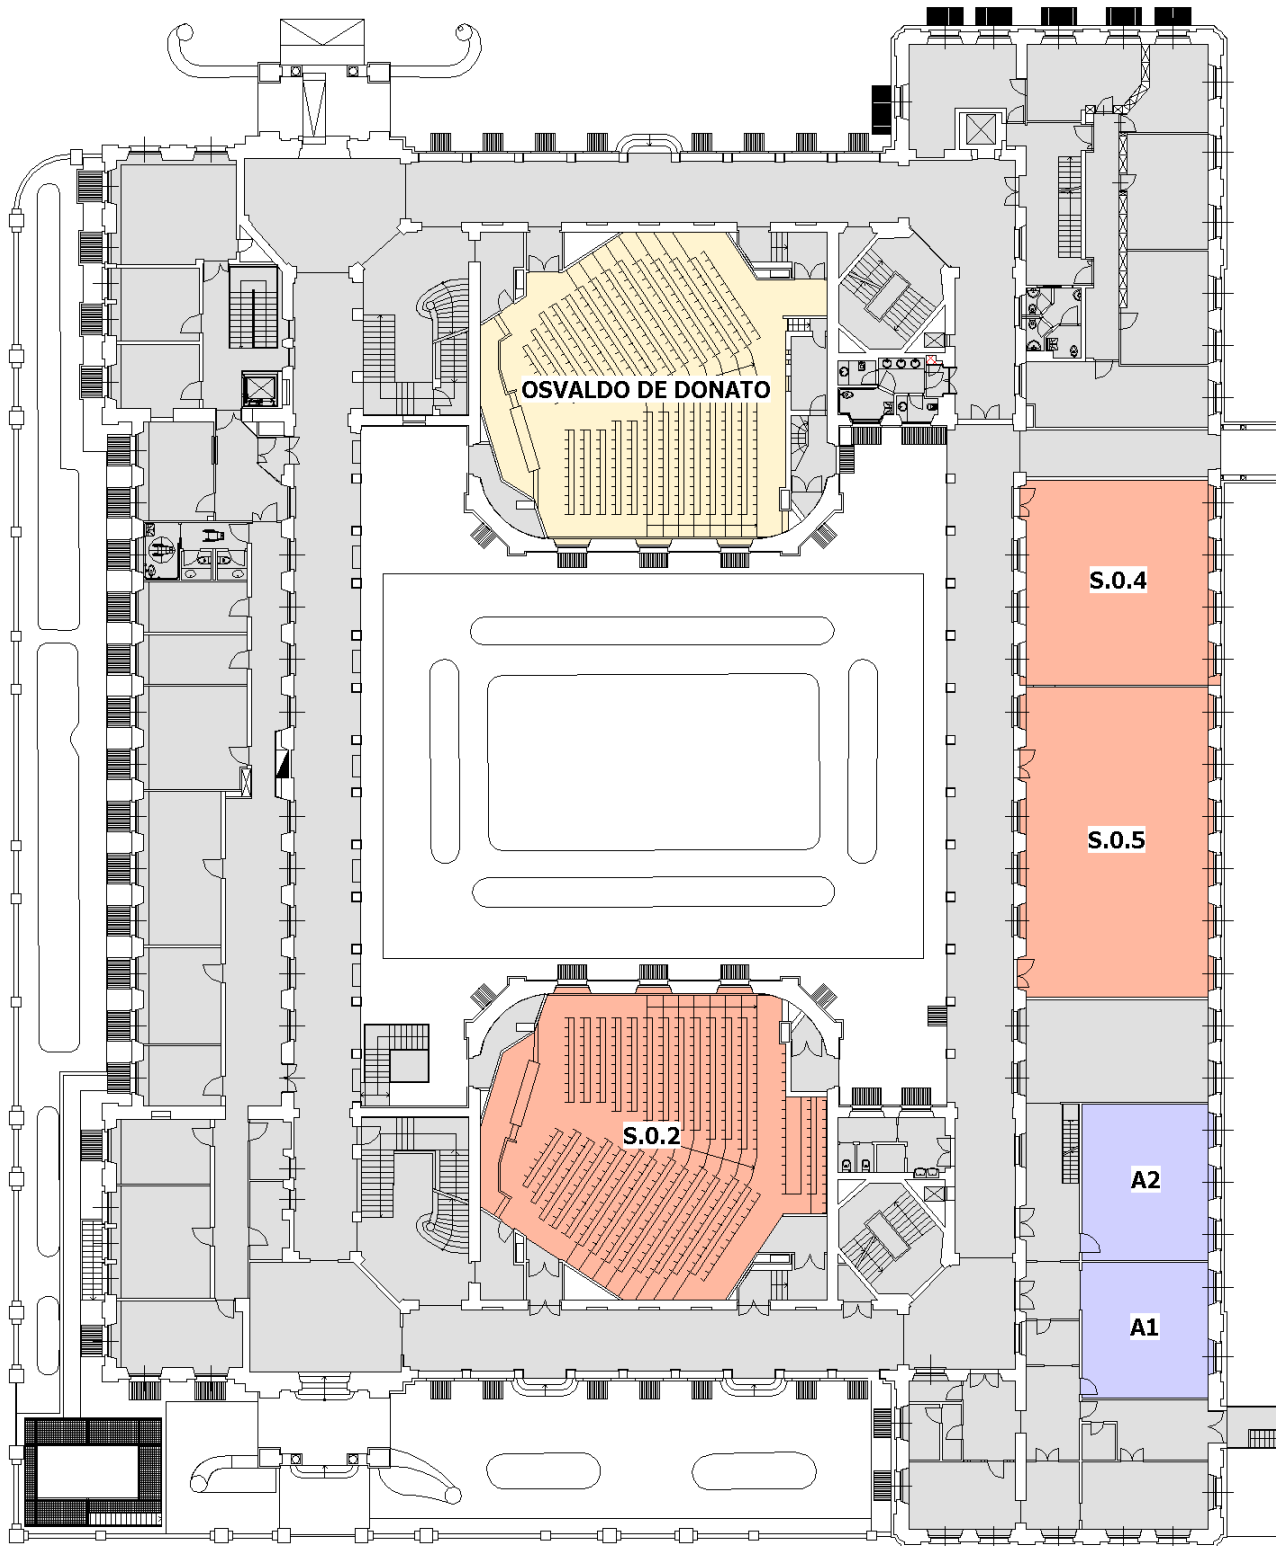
Pianta piano rialzato dell'Edificio 3
